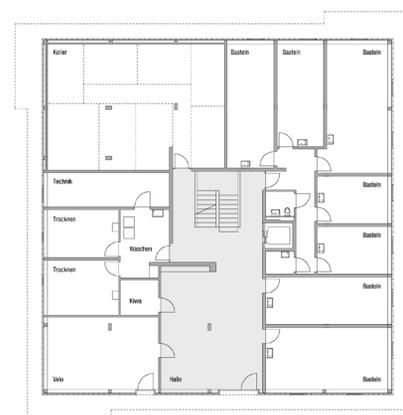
Wohnüberbauung Steinacker, Grundriss, Erdgeschoß
